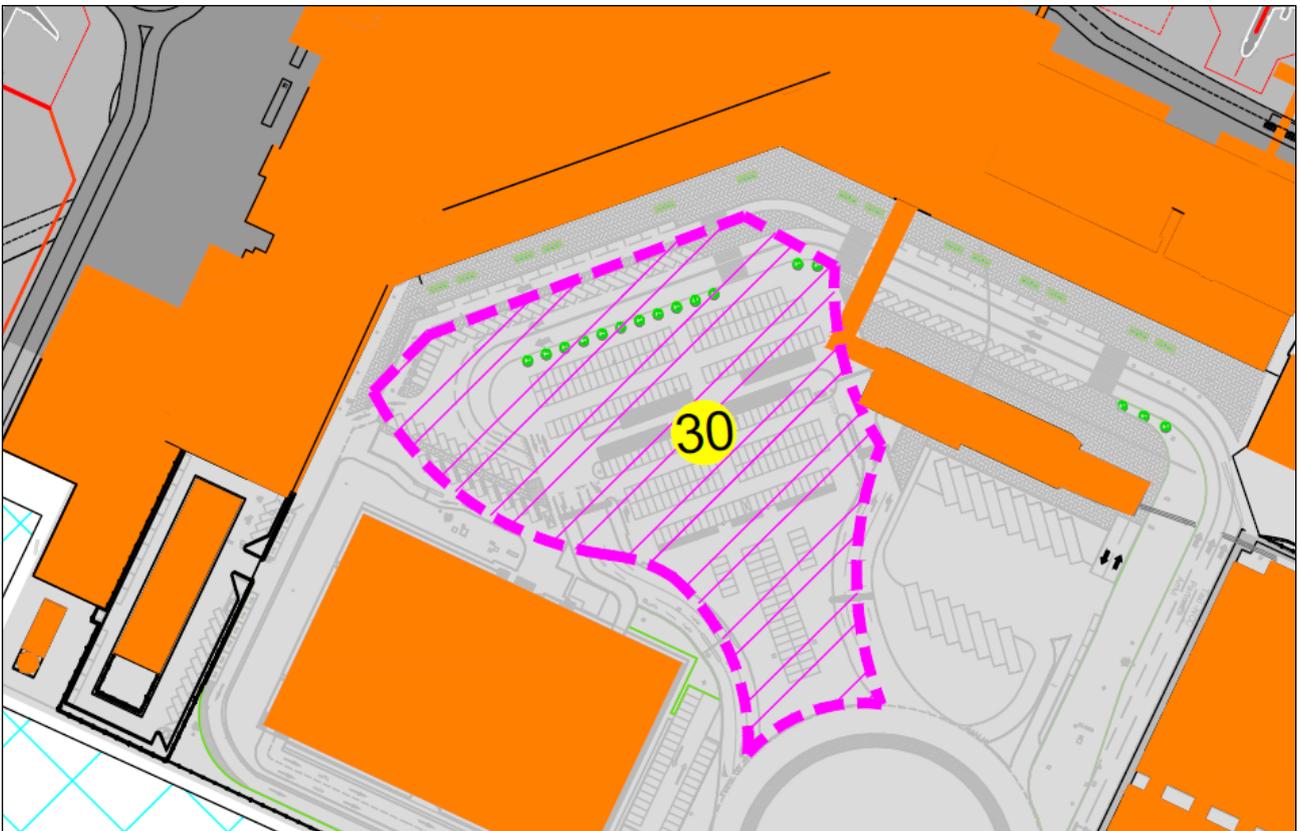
Estratto Master Plan – Riqualifica del Parcheggio P1
